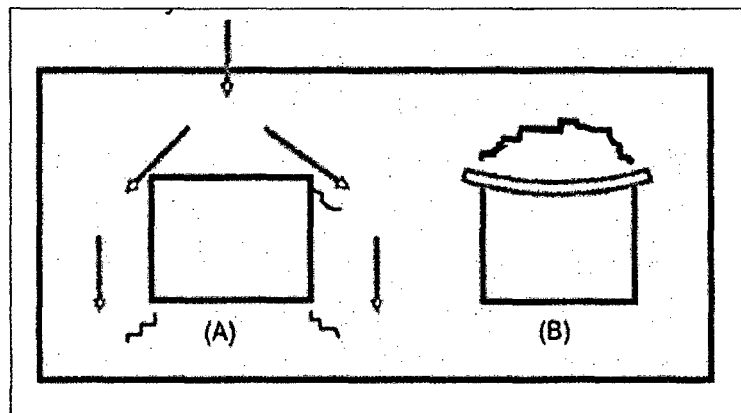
35. Fisuras en aberturas. Fuente: (Cámara , 2010).
